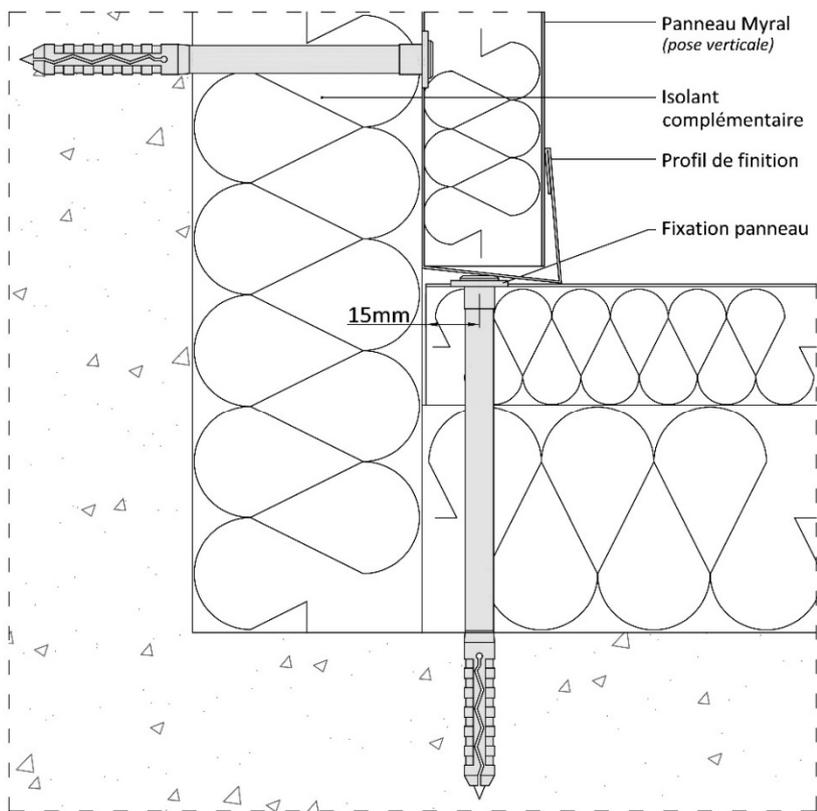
Angle rentrant – Pose en vêtire, lame verticale (coupe horizontale)
